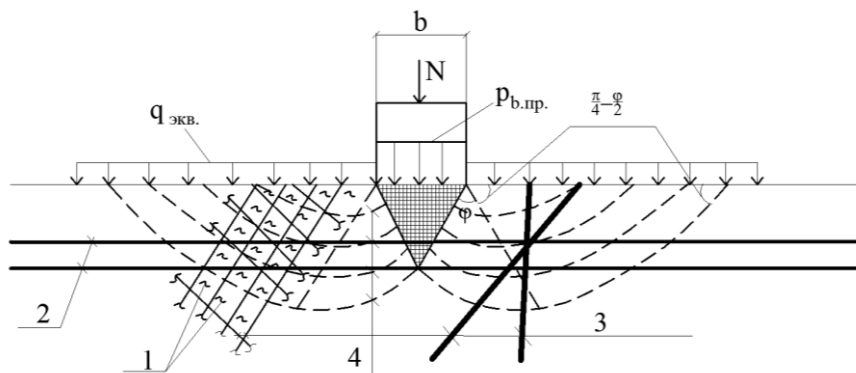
Схема армирования основания плитного (жесткого) фундамента армозементами: 1 – дисперсное армирование фиброэлементами по всему объему; 2 – линейно-горизонтальное армирование; 3 – линейно-вертикальное и наклонное армирование; 4 – линии скольжения (выпора) грунта при предельной нагрузке на основание $P_{б.пр}$
